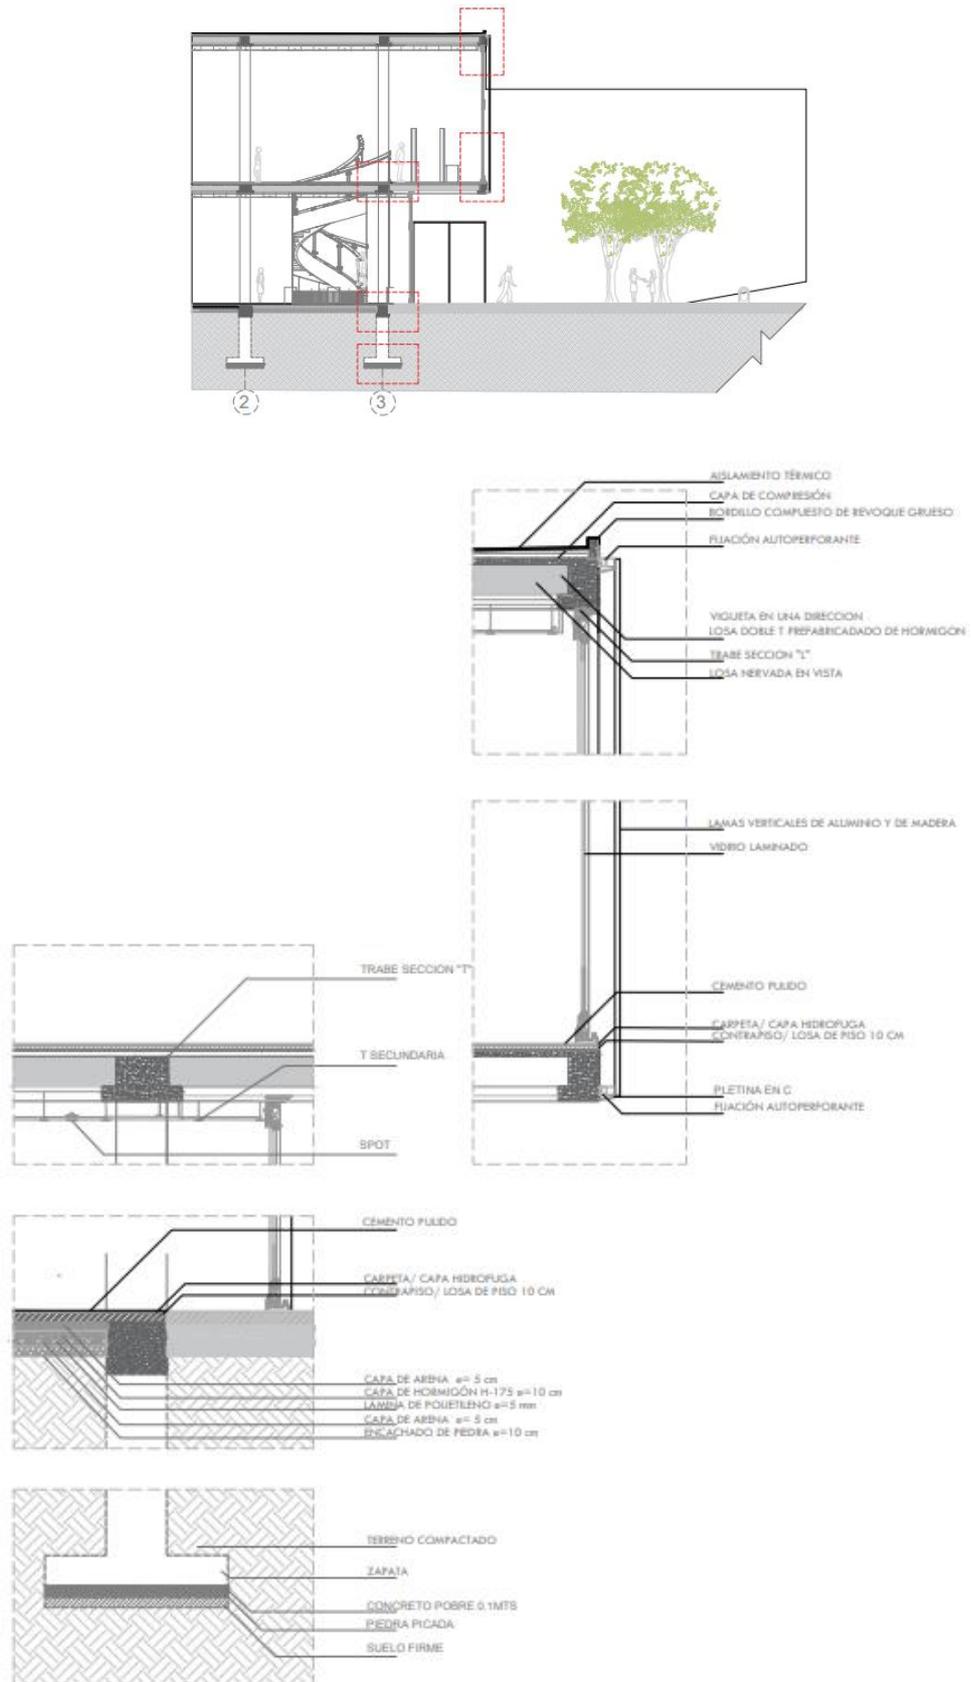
Corte constructivo a detalle- volumen de exhibiciones
